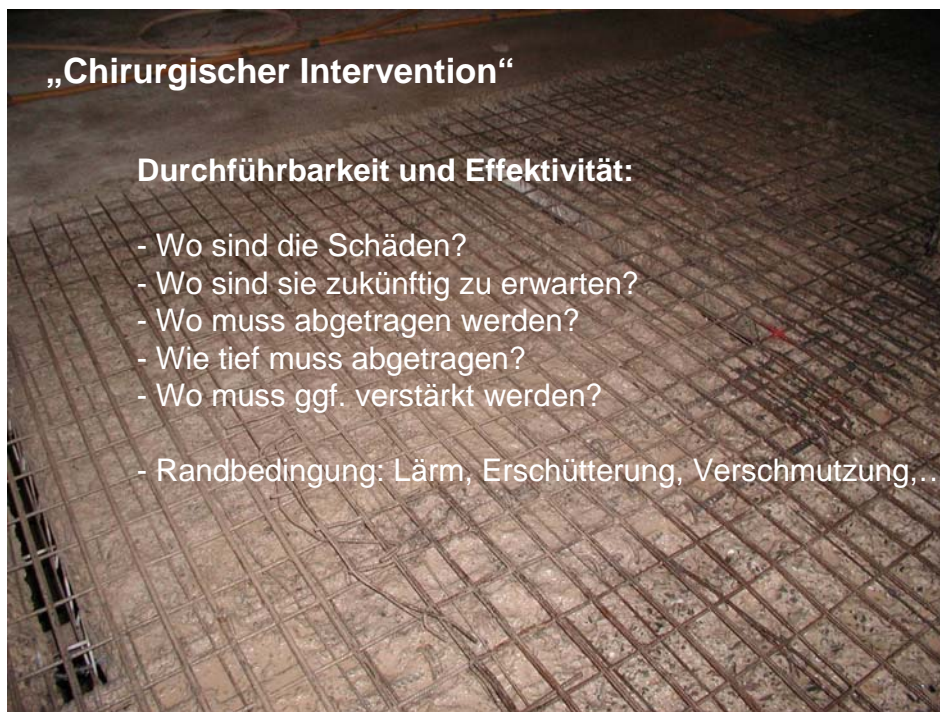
Fragestellungen, die im Zusammenhang mit üblichen betonabtragenden Instandsetzungsmaßnahmen mit anschließender Reprofilierung zu beantworten sind
